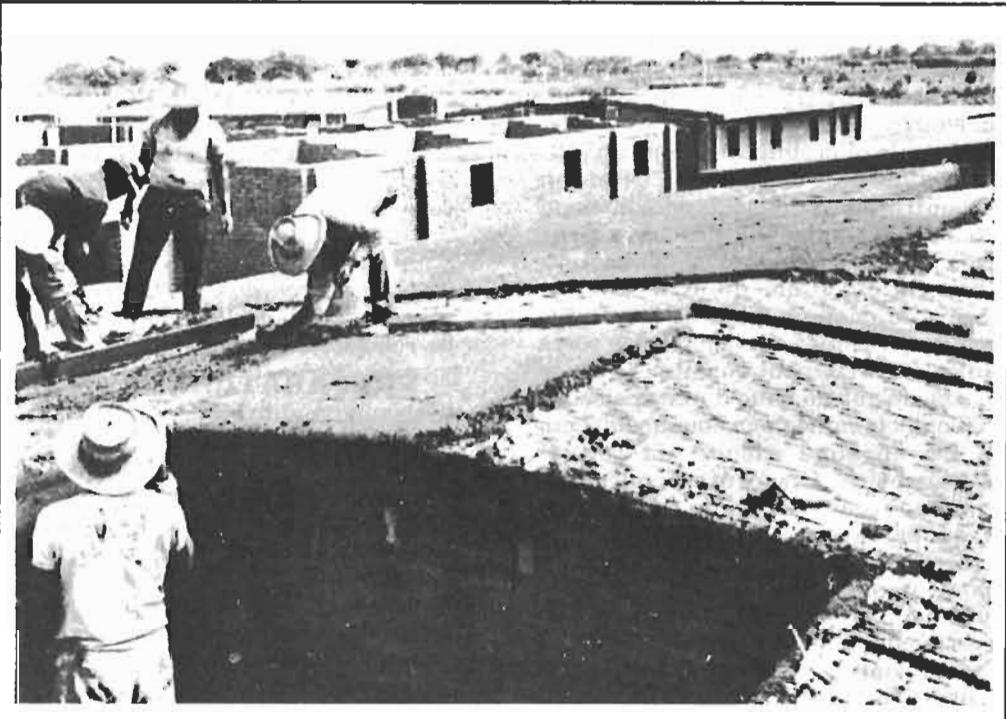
COULAGE DE LA TERRE STABILISEE SUR LE TOIT D'UNE DES MAISONS DE CAYALTI (PEROU). Cf. CHAPITRE « ADOBE »
